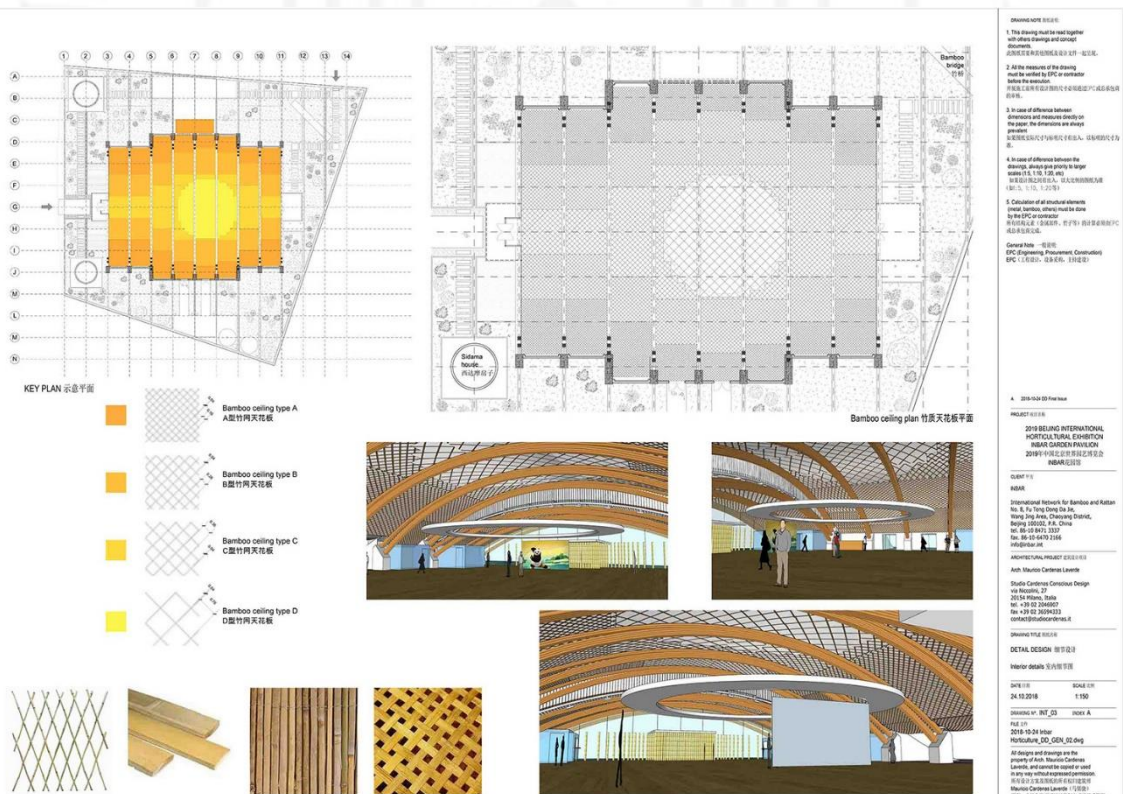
Planta, vistas 3d y tratamientos de techos
